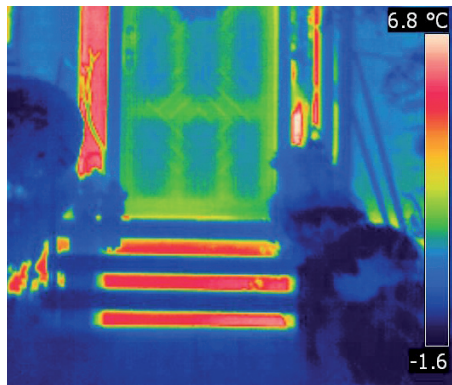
Hauseingangsbereich mit Wärmebrücken
